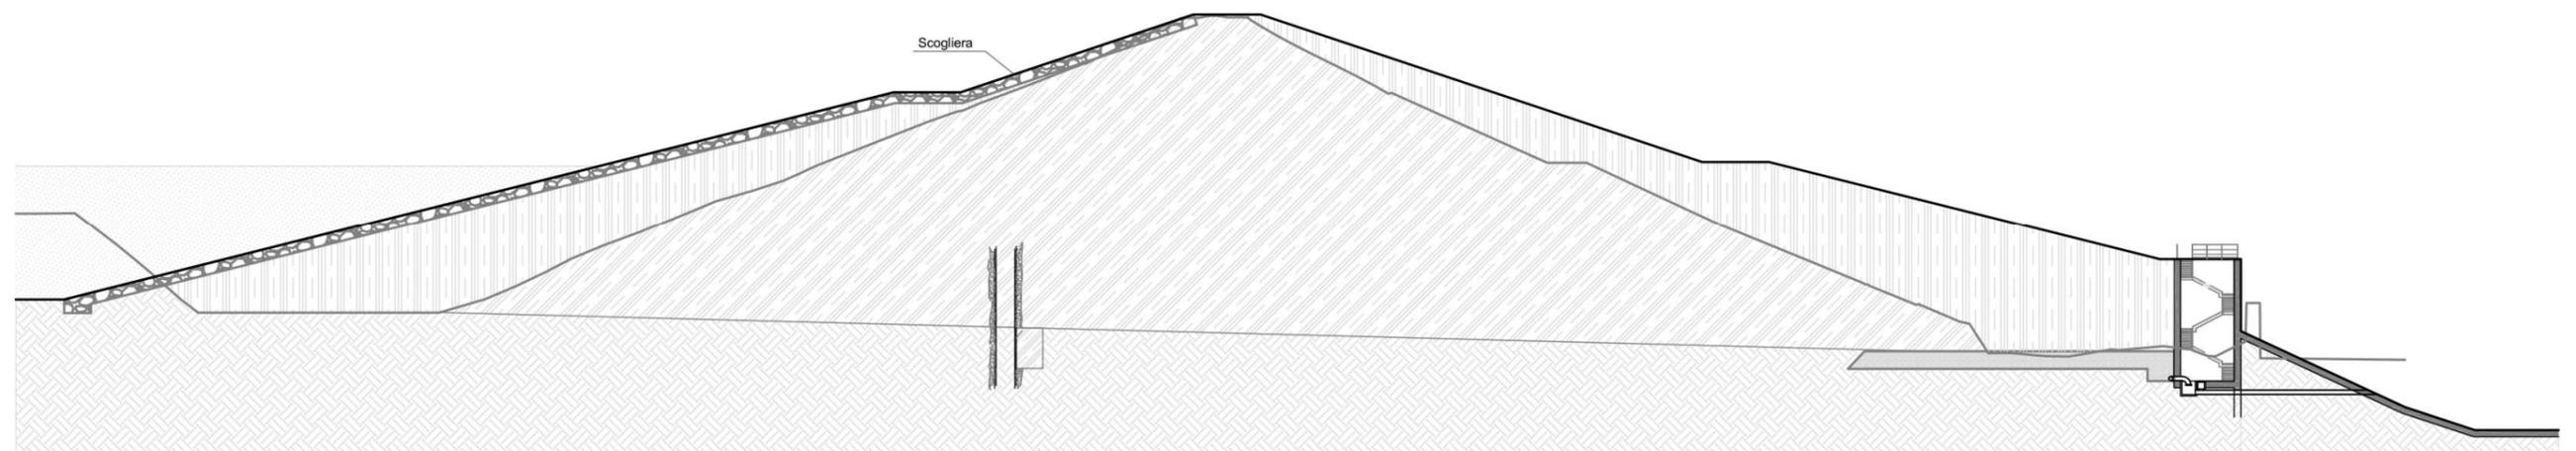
Sezione trasversale della diga Drove di Cepparello nello stato di progetto.
